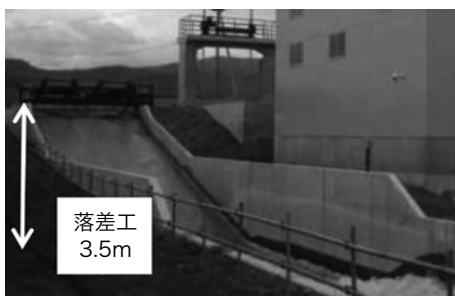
施工後(統廃合後)の落差工(研修会資料より)
